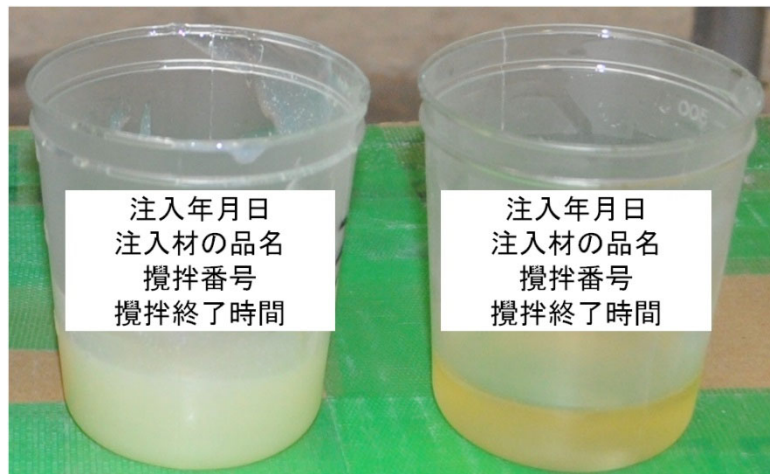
ひび割れ注入材の硬化時間の確認例
